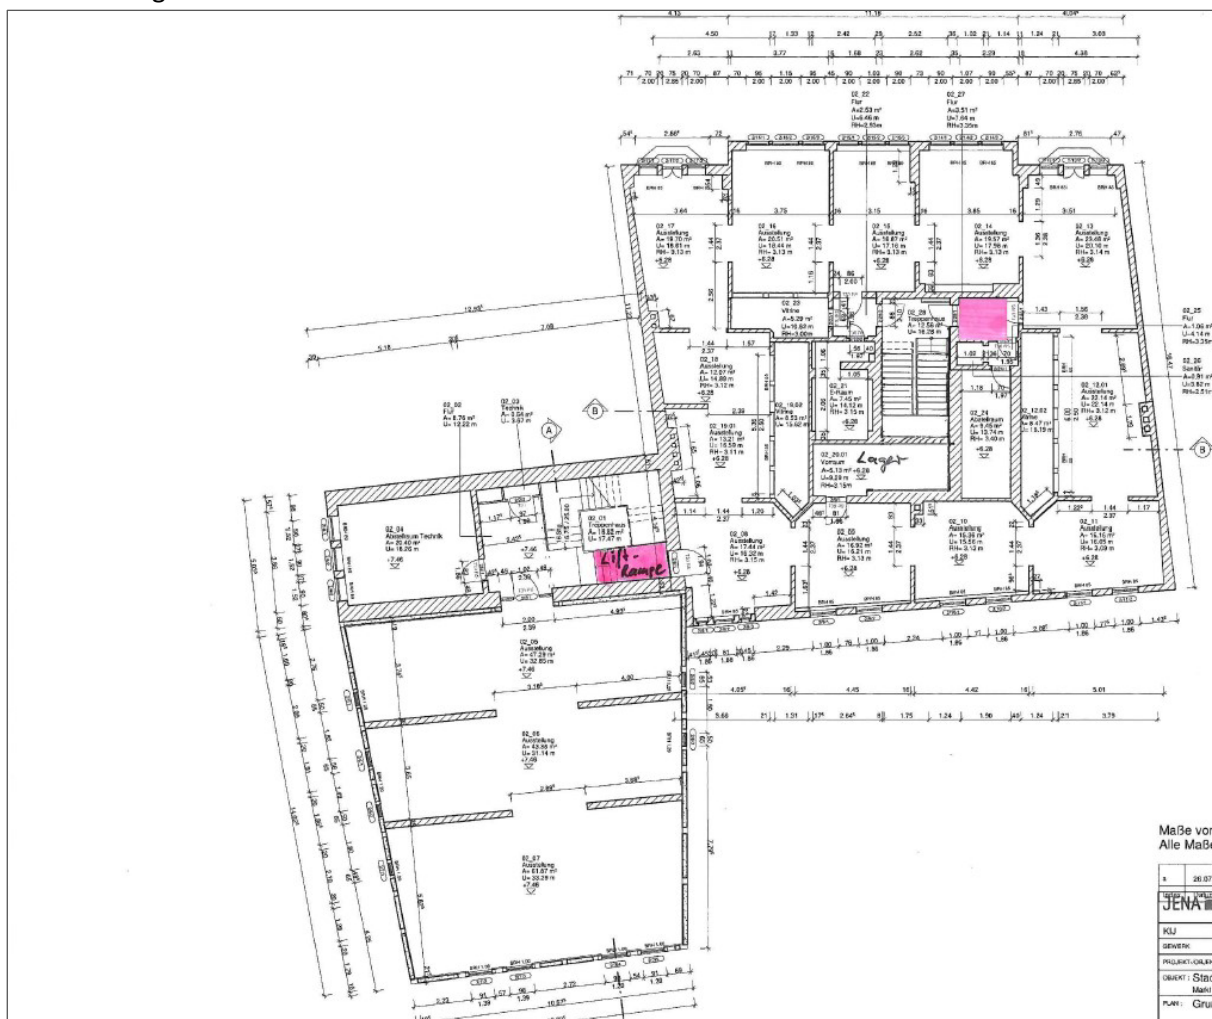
Grundriss 2. Obergeschoss, Positionierung Aufzug, Variante Lift Ost;
